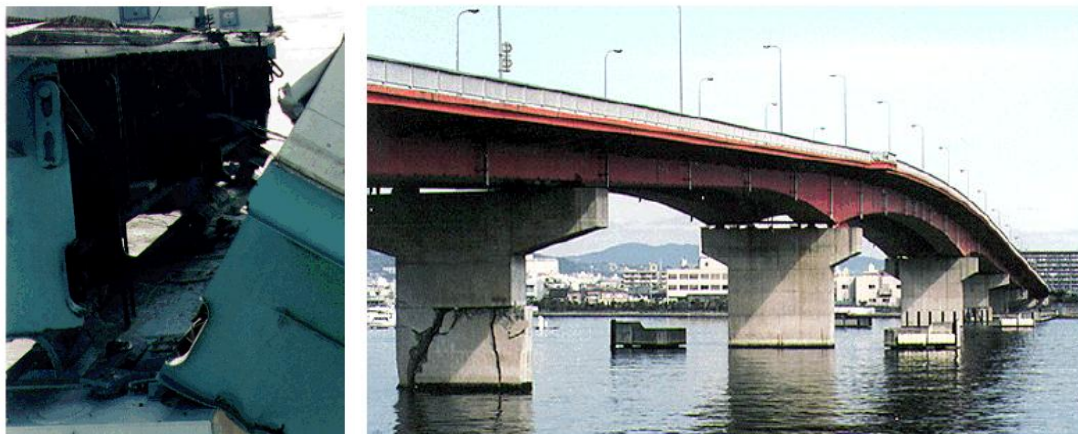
a) Falla de los apoyos del puente de arco en el Wangan Expressway. b) Falla de las pilas de bajo del Puente Great Nishinomiya, al menos seis pilas tipo muro fueron severamente dañadas. (Fotos: U.S. Geological Survey).
